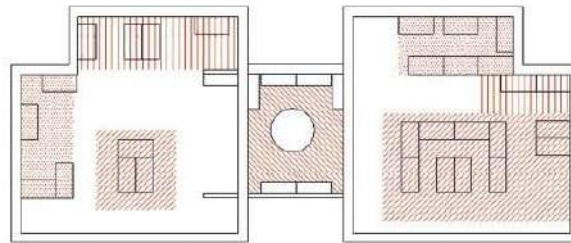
Plan d'étage repris par l'auteur du plan d'évacuation
